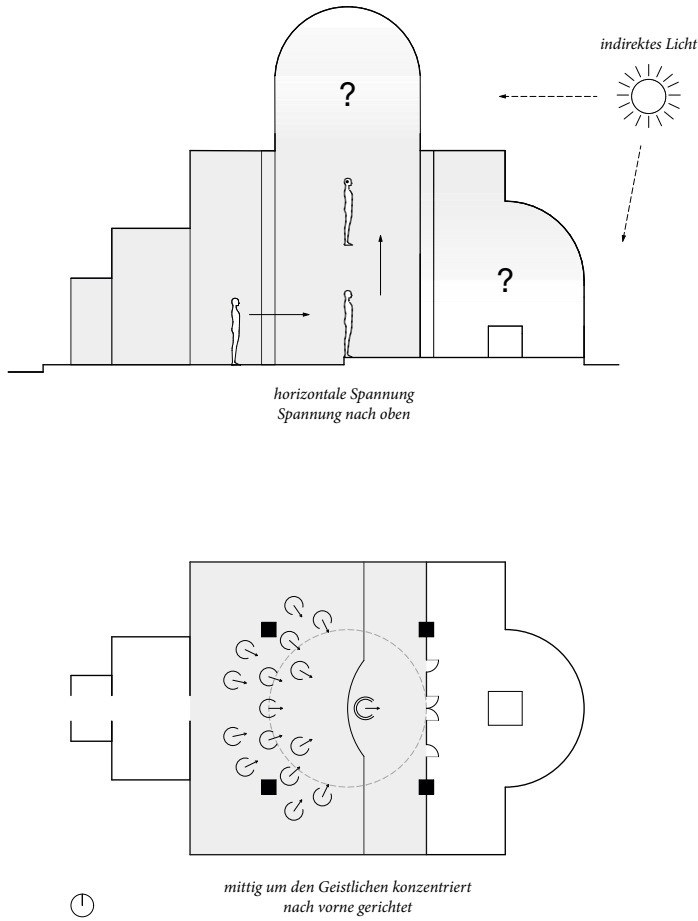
symbolischer Schnitt und Grundriss mit Prinzipien der Raumwahrnehmung
